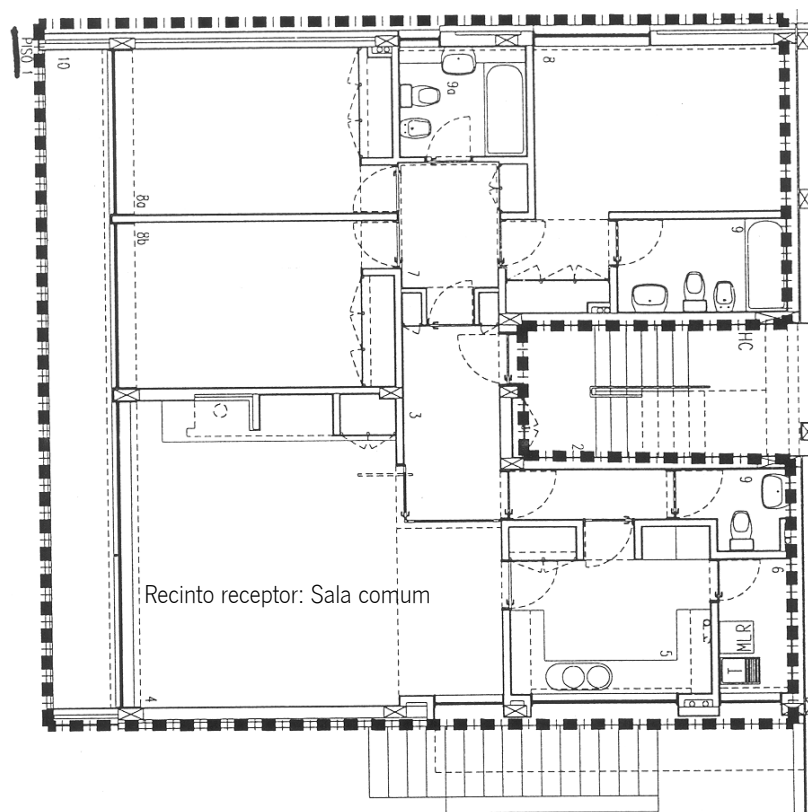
Planta do recinto receptor do ensaio de avaliação do isolamento da parede exterior 1, ParE1
